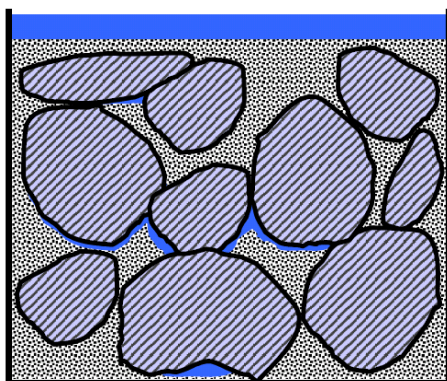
Schematische Darstellung des Wasserabsonderns im Beton [Lit 6]
